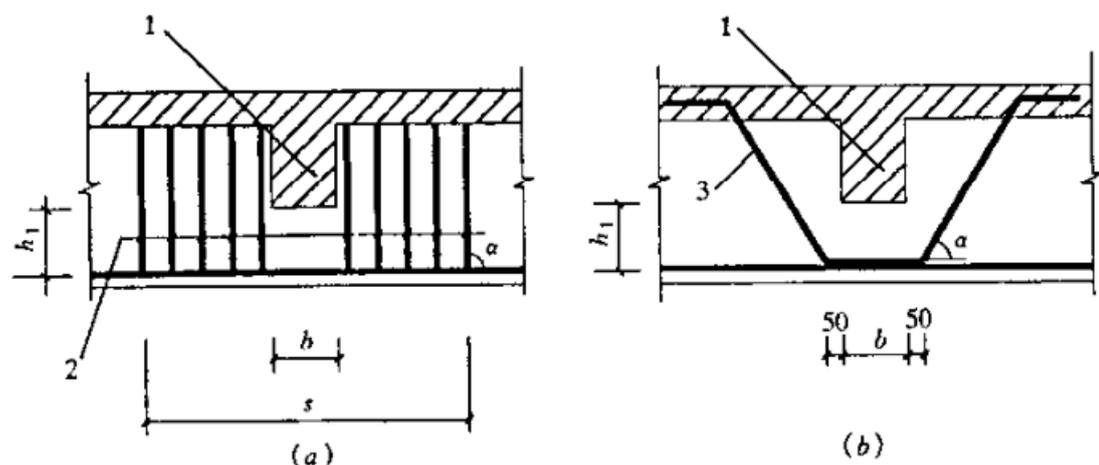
梁截面高度范围内有集中荷载作用时附加横向钢筋的布置
